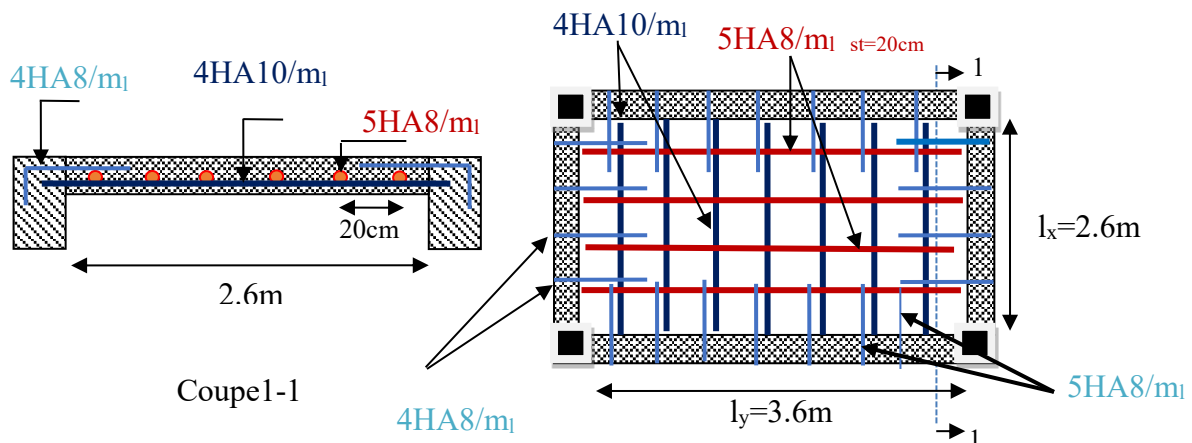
Schéma de ferrailage de dalle sur quatre appuis
